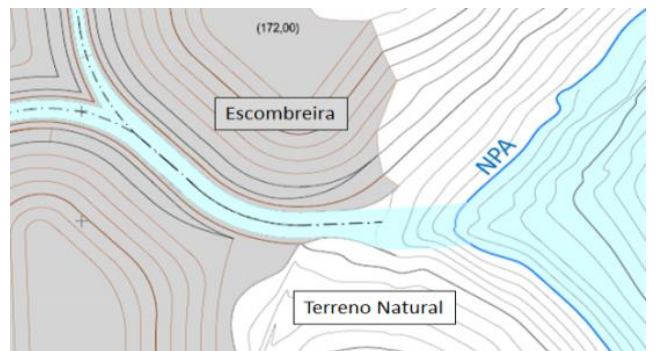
Planta da zona de restituição do escoamento à albufeira.
